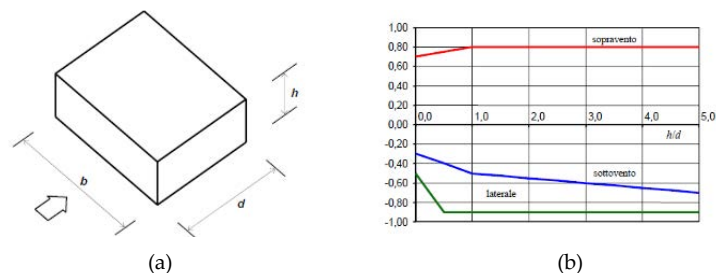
a) Parametri caratteristici di edifici a pianta rettangolare, b) Edifici a pianta rettangolare:  $c_{pe}$  per facce sopravvento, sottovento e laterali
